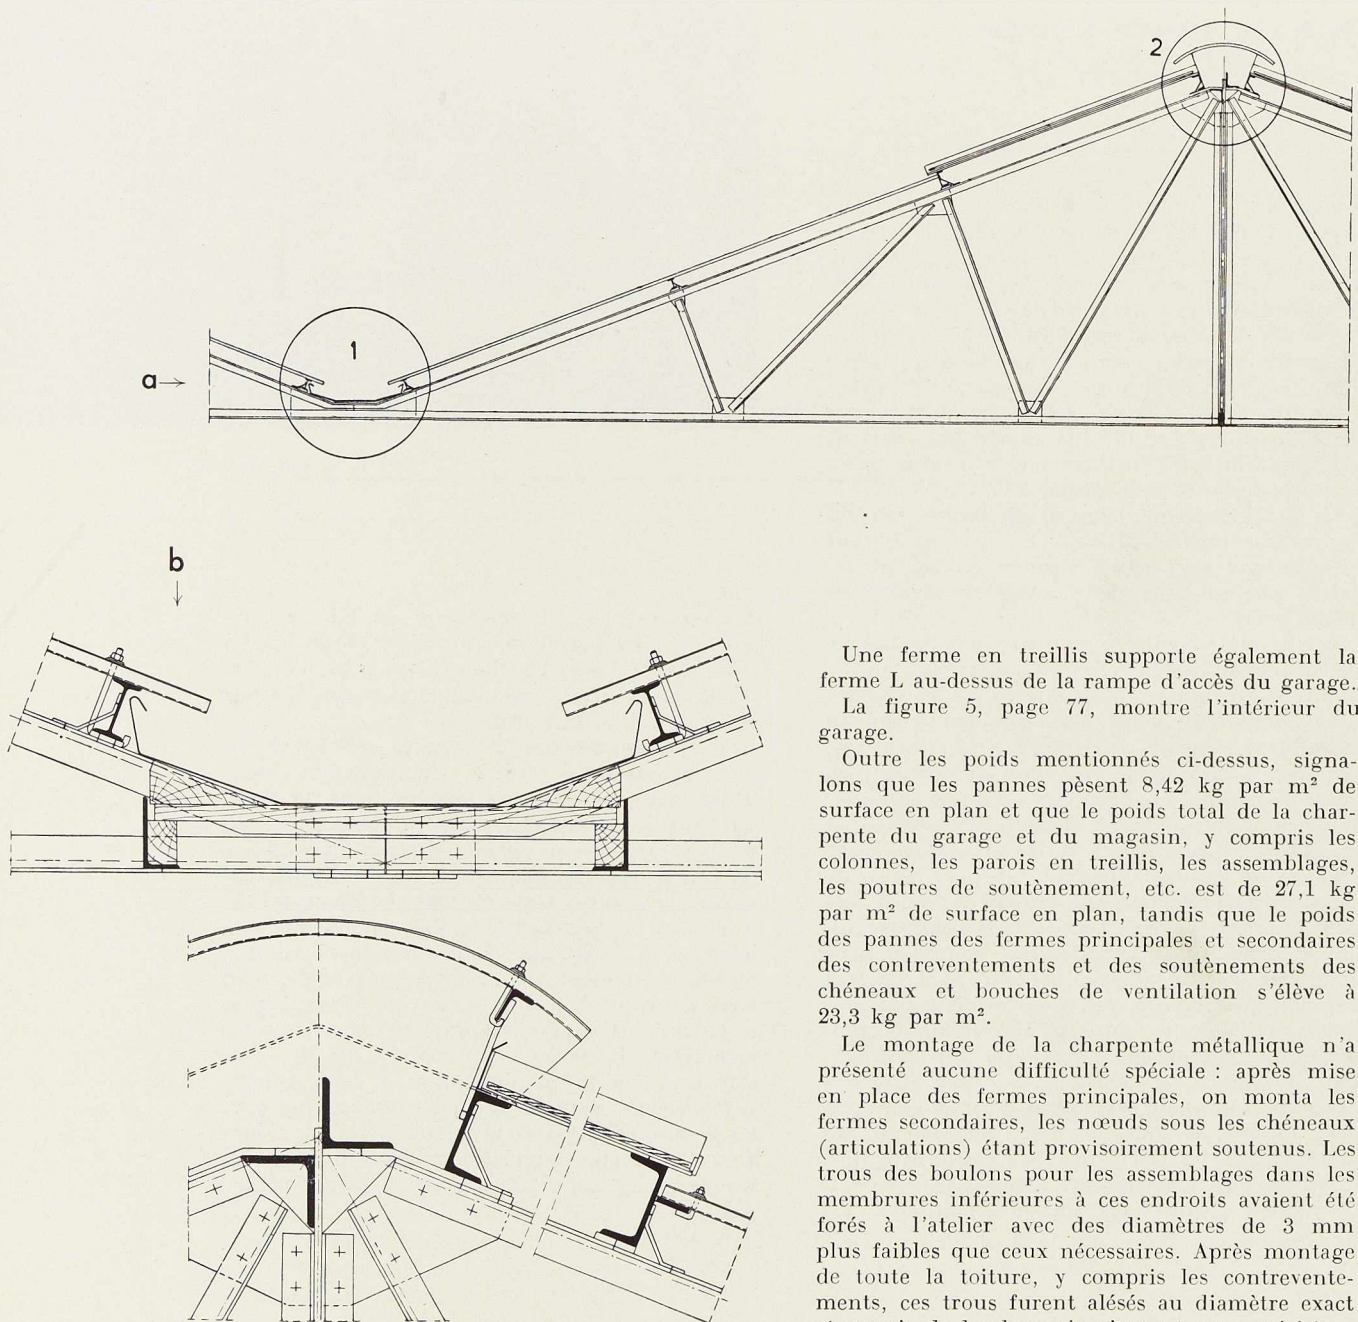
a (au-dessus). Fermes secondaires avec chéneaux (1) et bouches de ventilation (2).
